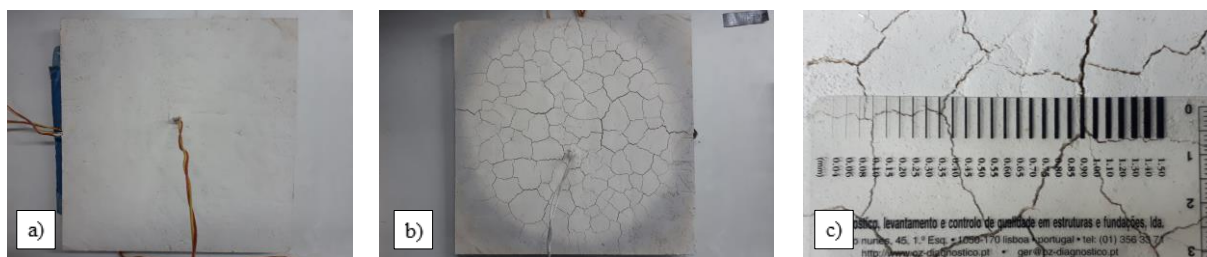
Provete P_A1_3: a) Provete antes do ensaio; b) Provete após o ensaio; c) Fissuração do provete após o ensaio.
